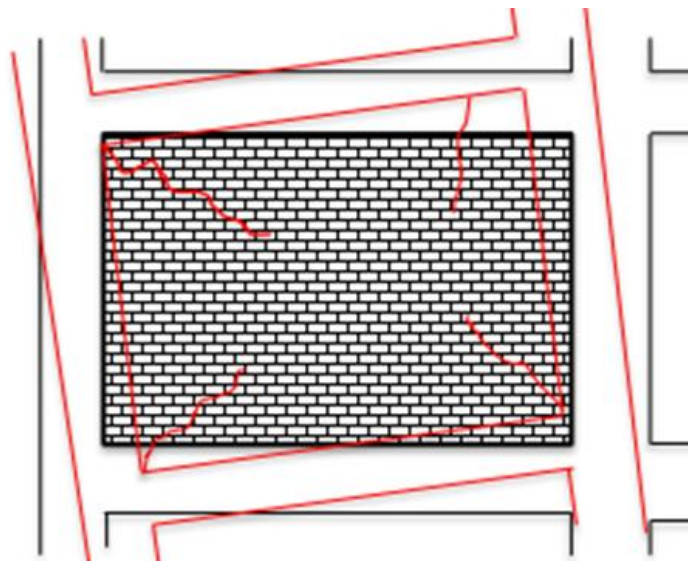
Efecto que Causa la Inclinación del Edificio Sobre Muros de Mampostería. Fuente: Elaboración propia
